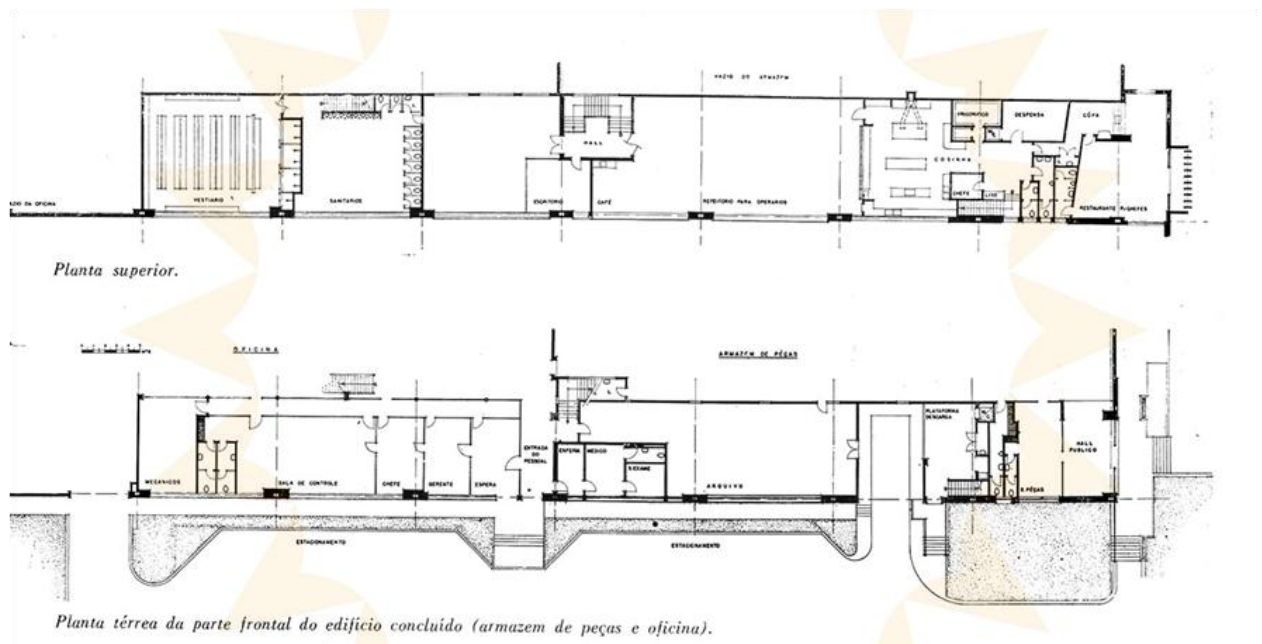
Planta do térreo e pavimento superior do armazém de peças e oficinas.
